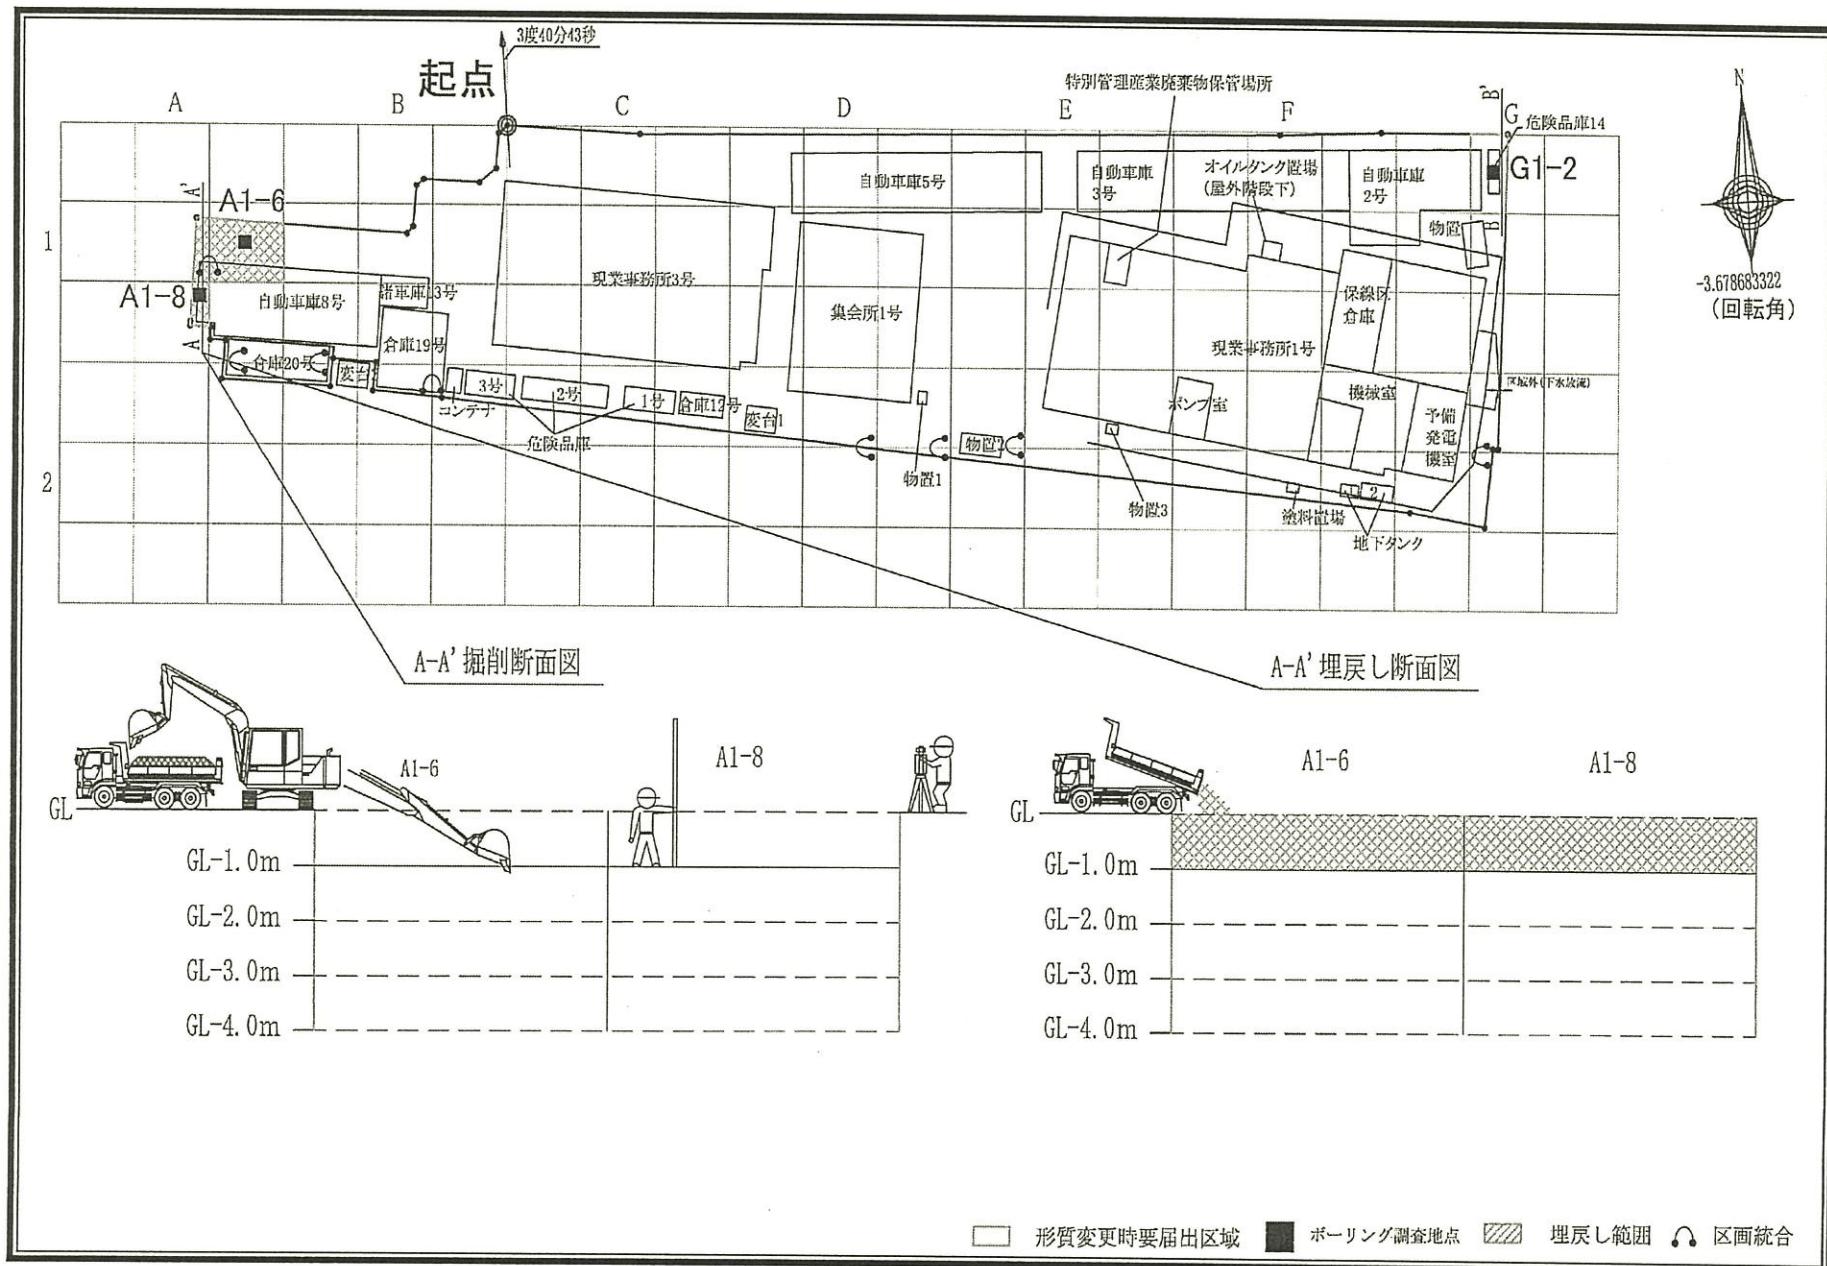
措置対策施工平面・断面図 (A1-6, A1-8 区画)
